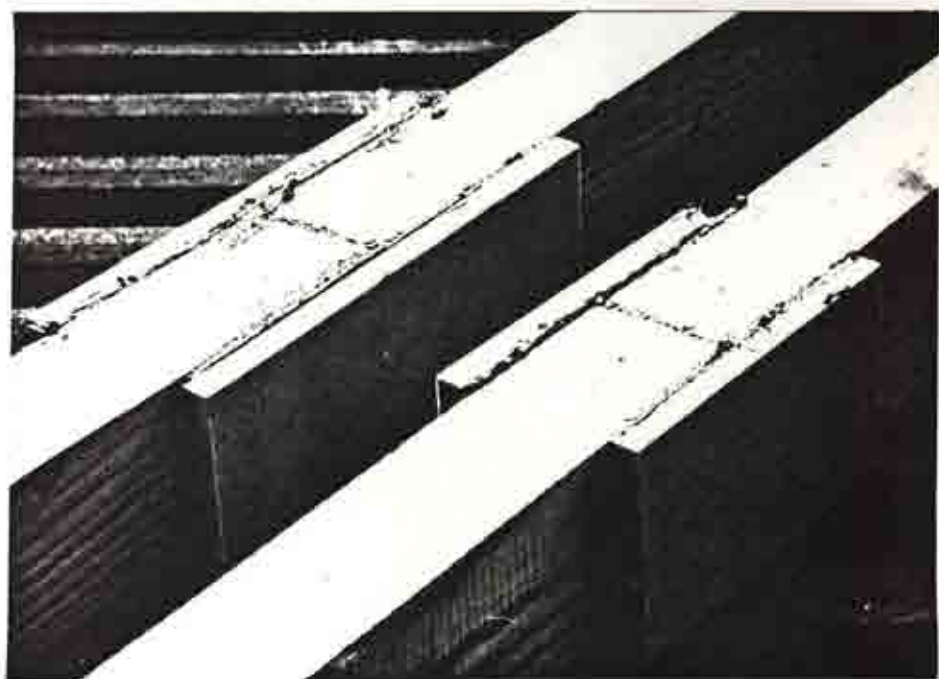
Detalle de las placas adosadas externamente en las probetas comentadas en la fotografía anterior.
